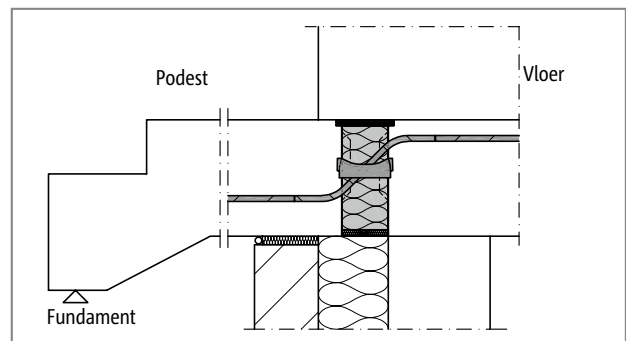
Schöck Isokorb® T type Q-E: Aansluiting bij buitenisolatie
